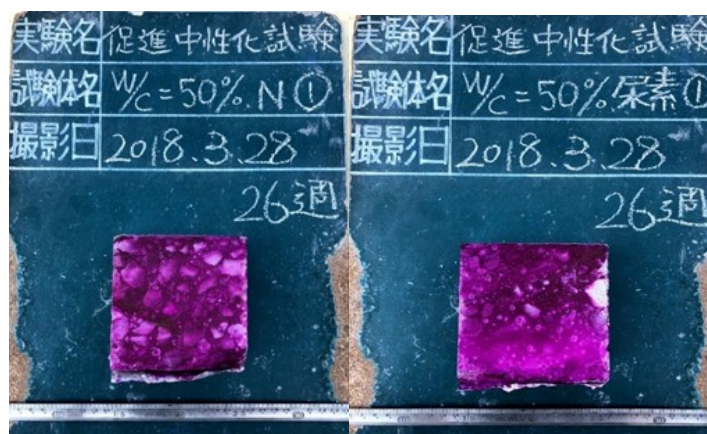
W/C=50%の供試体断面写真（26週目）
